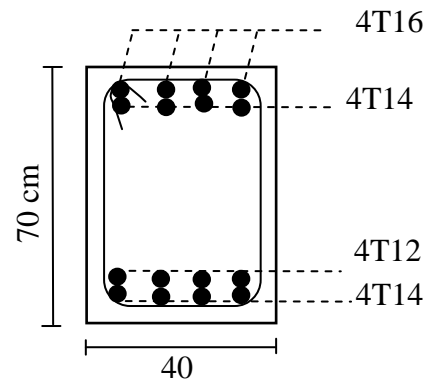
Ferrailage de la poutre de libage (exemple PL SF3)
